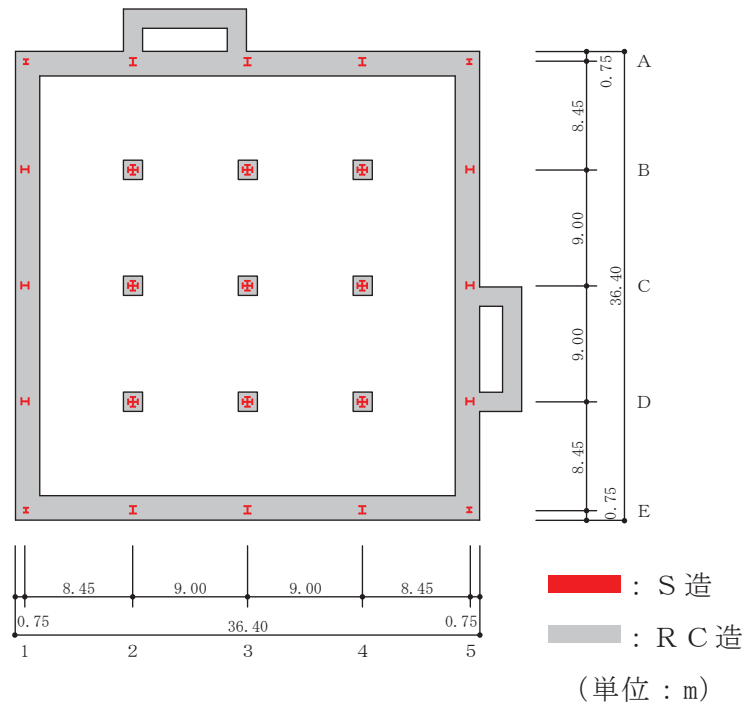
(2) 緊急時対策建屋の概略平面図 (O.P. 57.3m)
